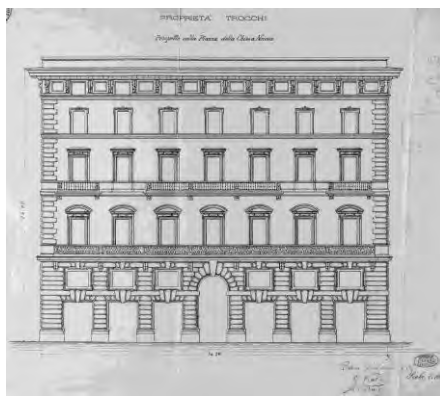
palazzo Trocchi prospetto su piazza della chiesa Nuova
